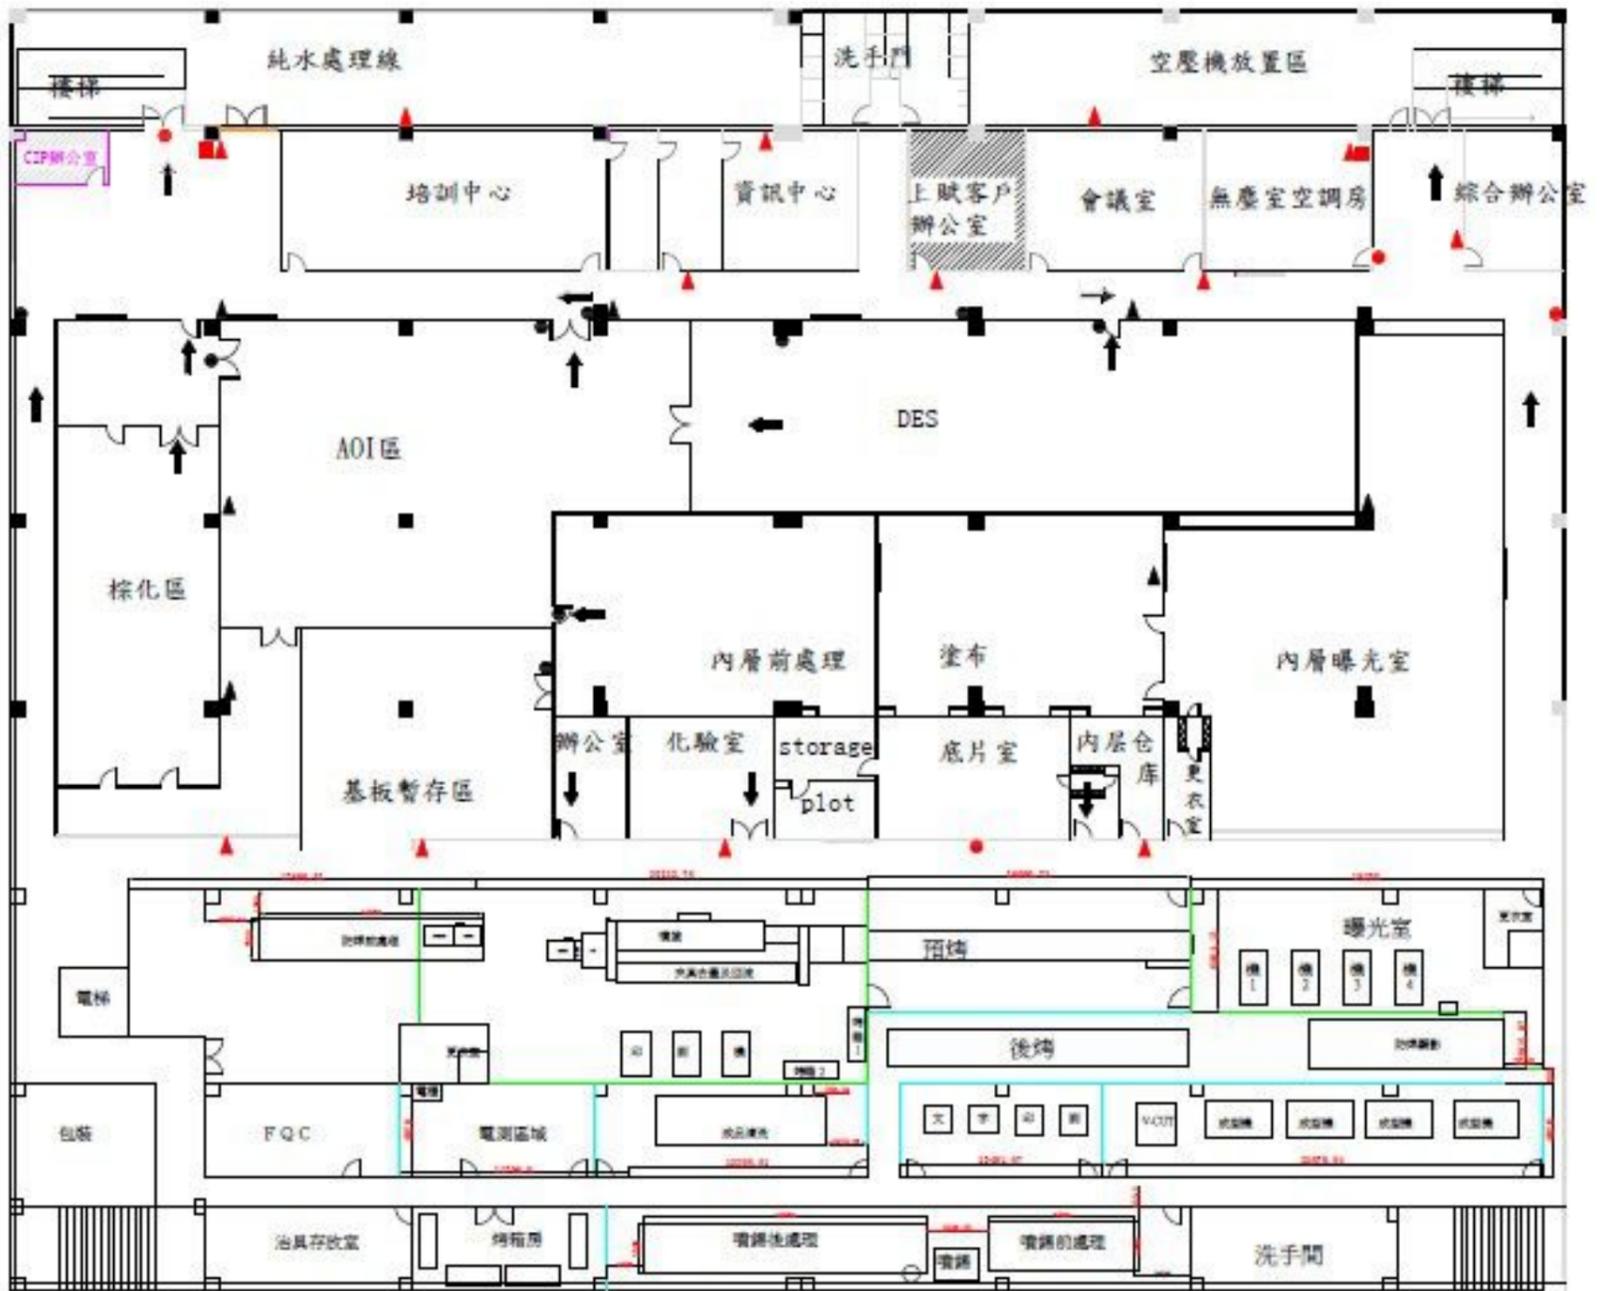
建设项目车间（二厂）二楼平面布置图
